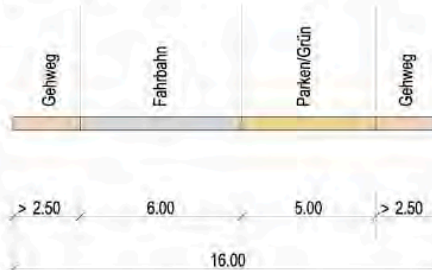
Testentwurf Bereich 1: Ausschnitt Bahnhofstraße
